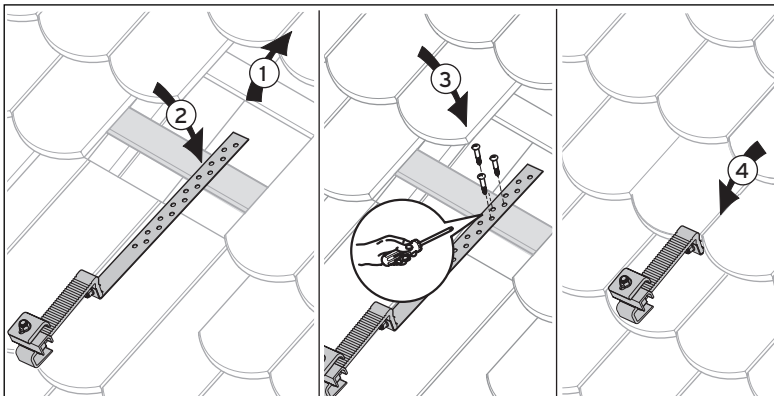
Dachanker Typ S flach befestigen (hier dargestellt: Befestigen an der Dachlatte)
